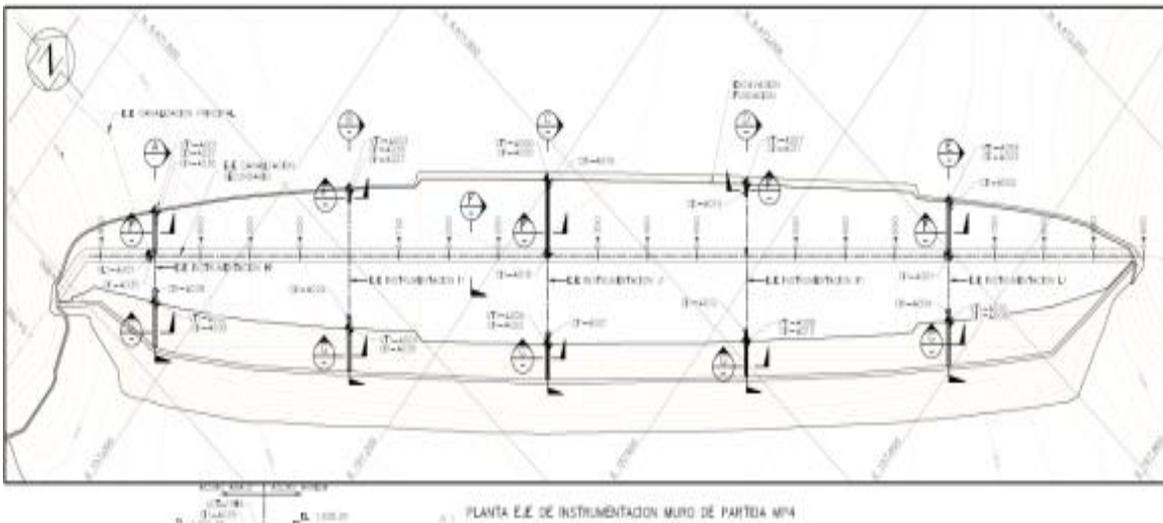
Planta general Muro N°4 MQCL-ST54-IND-5411-PLN-CVES-0061
